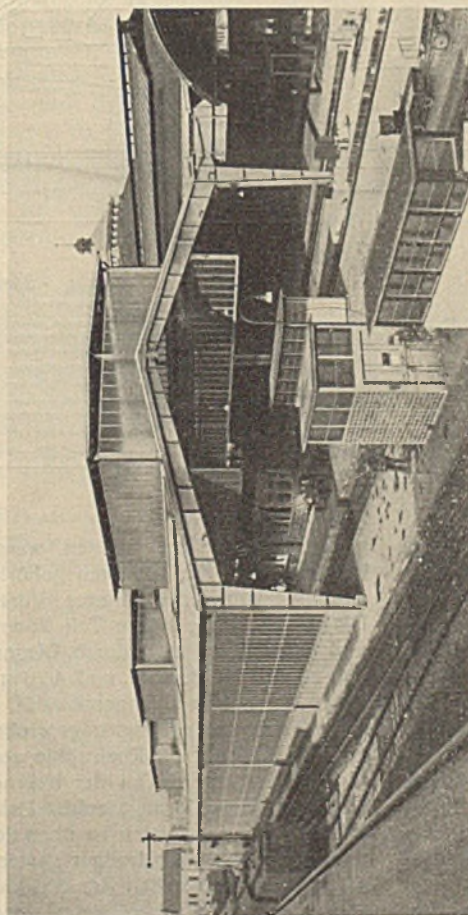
Bahnsteighalle auf Bahnhof Halle.
